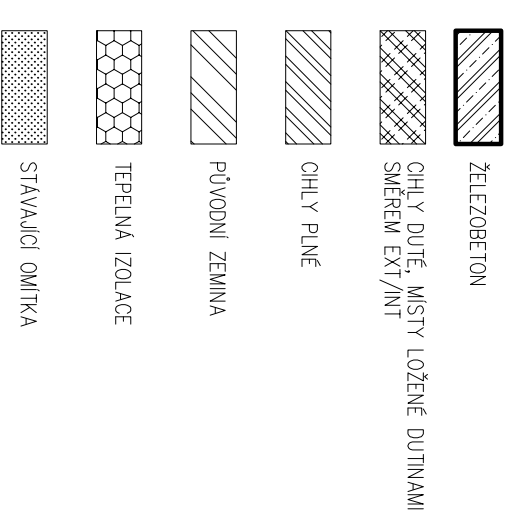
ZATEPLENÍ DO DVORA NAVRHOVANÝ STAV
